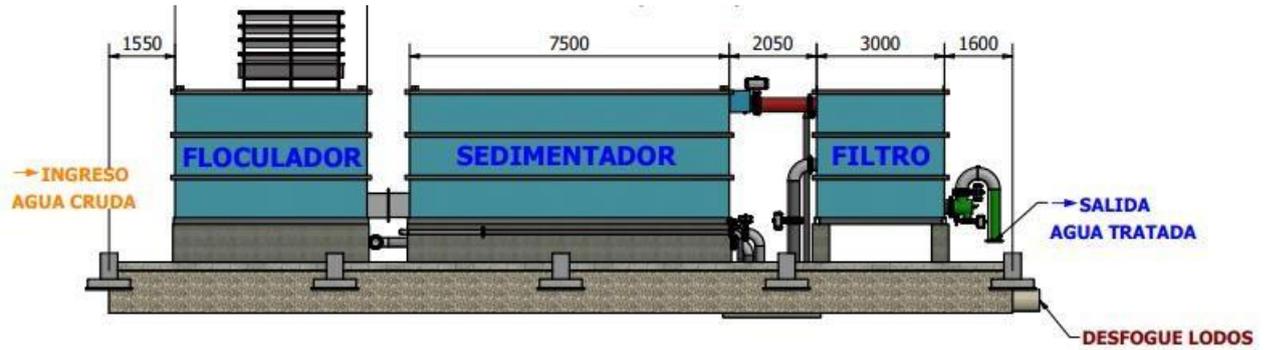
Vista en corte de la planta modular de capacidad 7500m³/d
